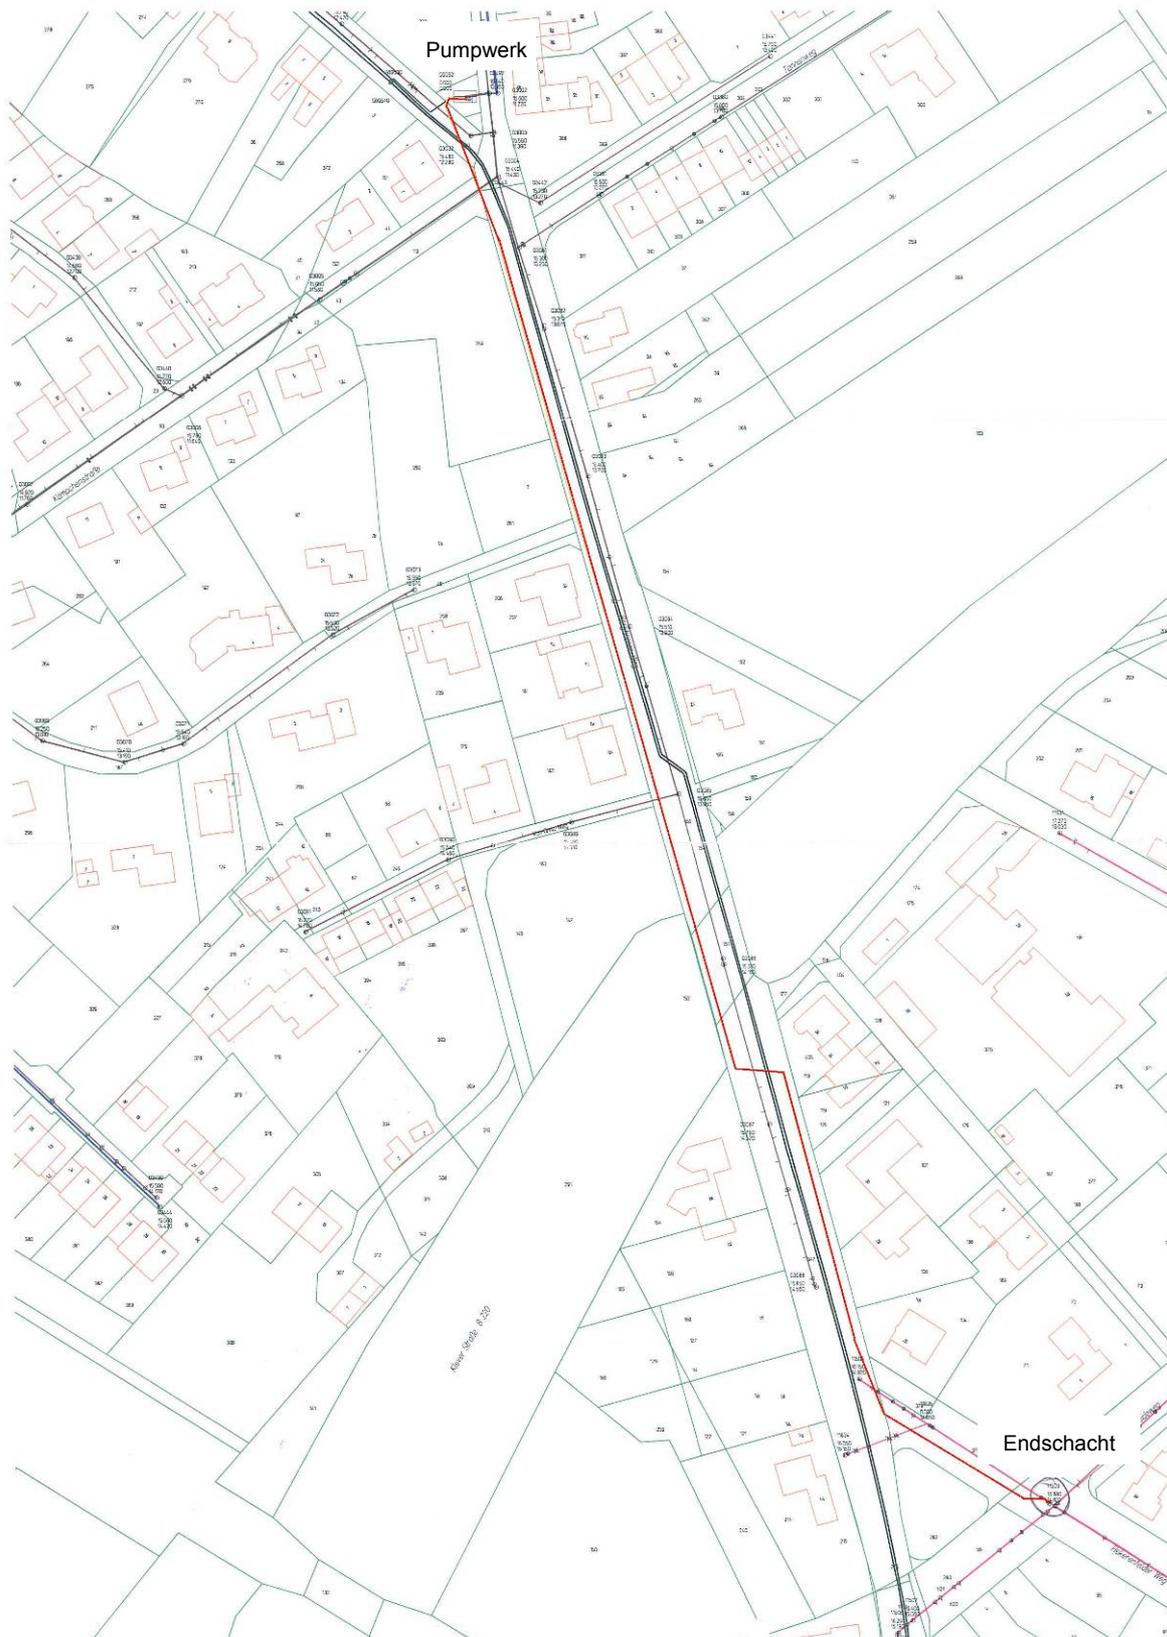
Lageplan Druckleitung PVC DN 200, Länge 440 m, Emmerich am Rhein
